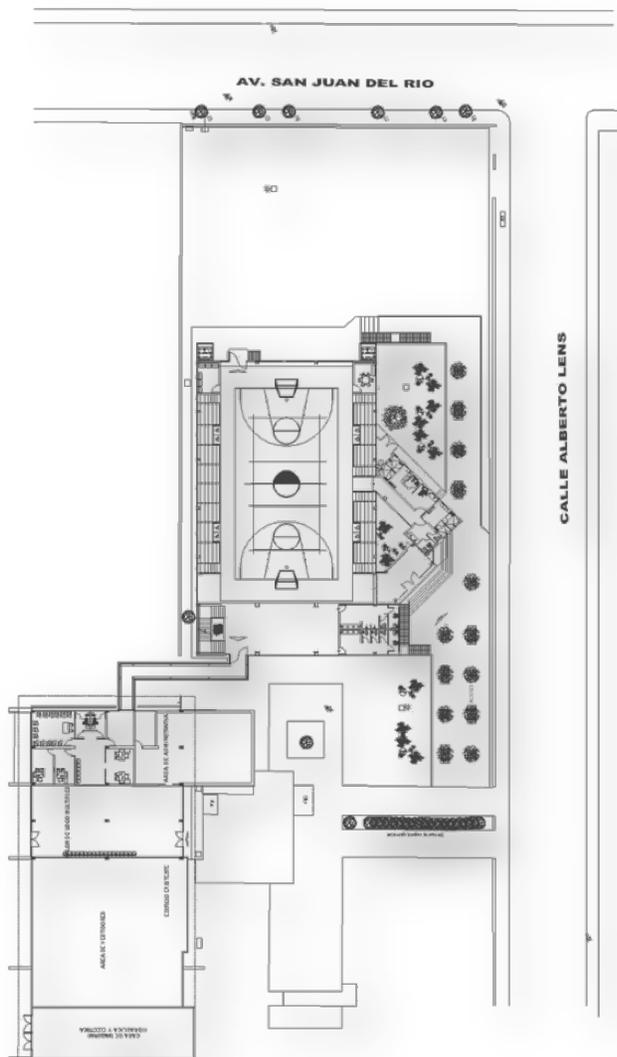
Planta arquitectónica de la Unidad deportiva de Zacapu. Dpto. Constr. del IMSS.
